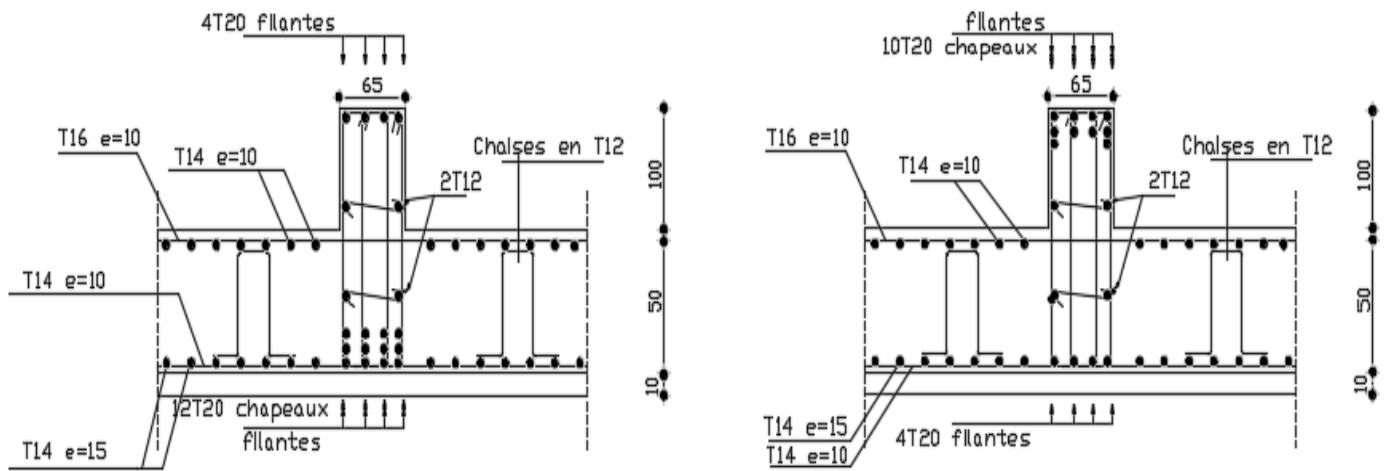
Ferrailage de la poutre principale en travée et en appui.
